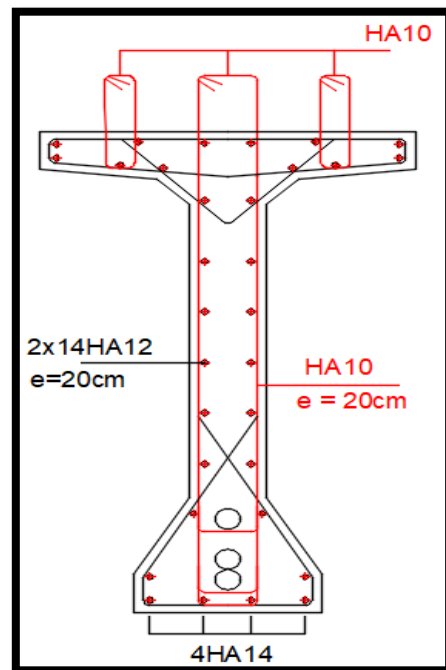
Ferrailage de la poutre à mi-travée
